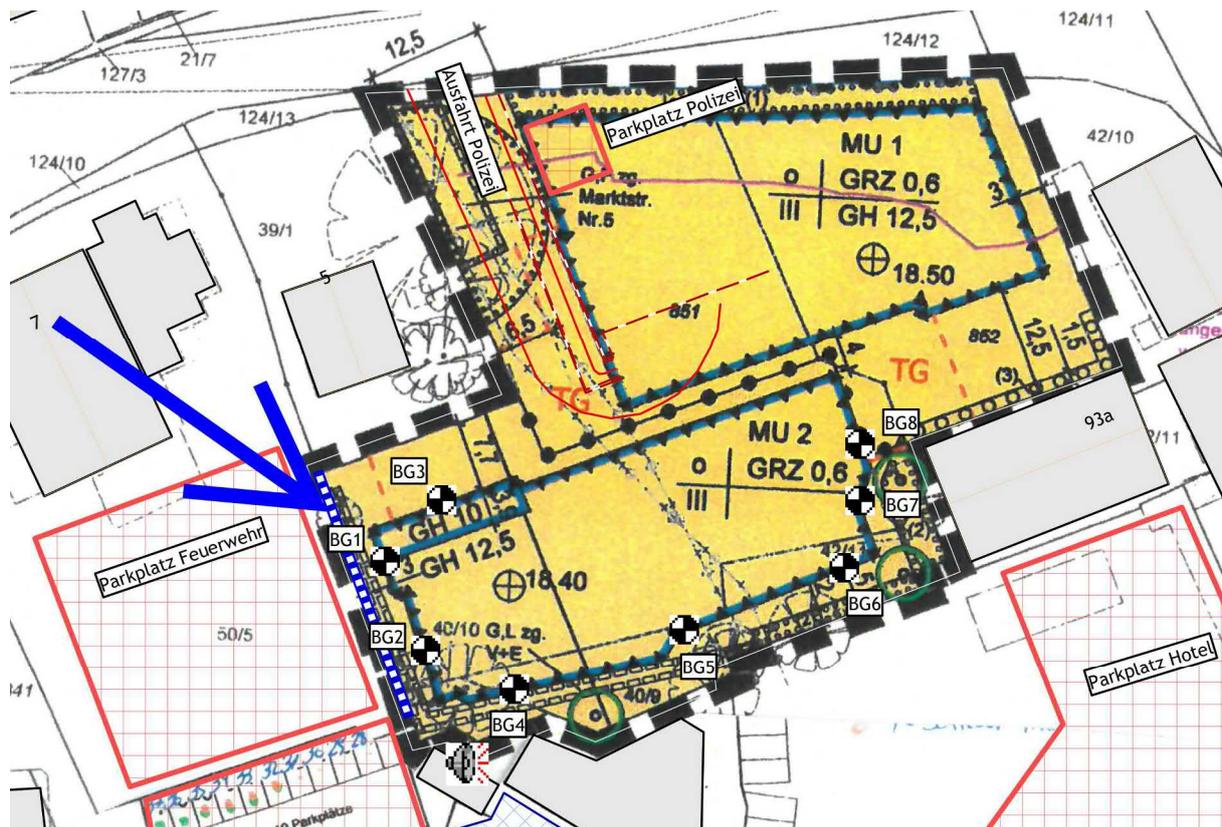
Lageplan Gewerbe / Lage der Lärmschutzwand
